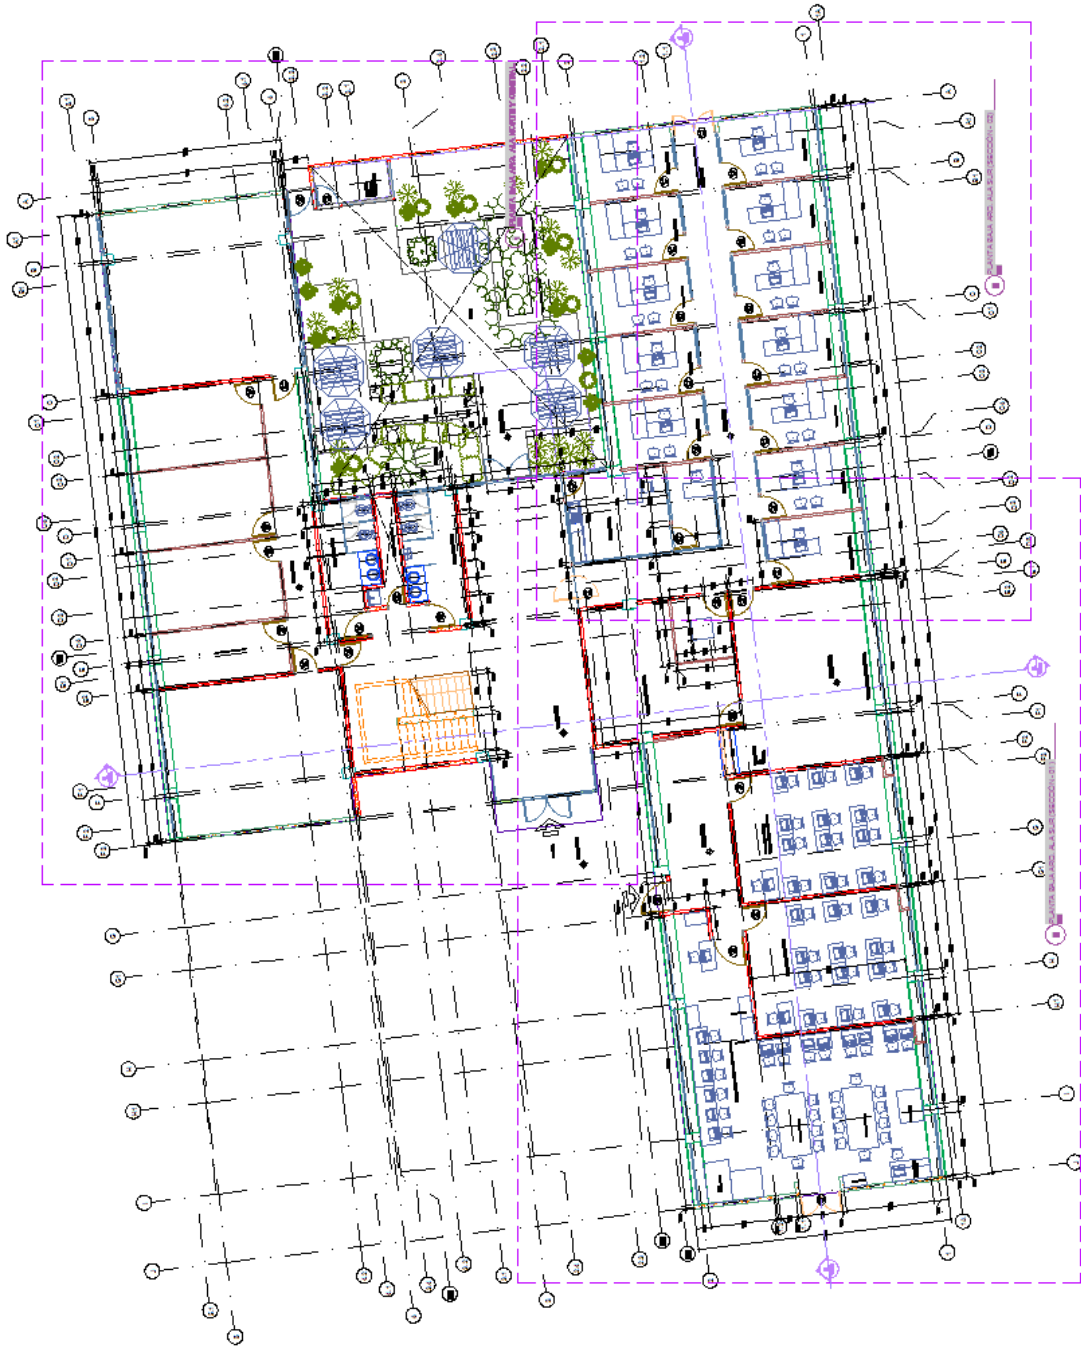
Planta arquitectónica localizando las secciones de la Vista de la Planta Baja ya remodelada
